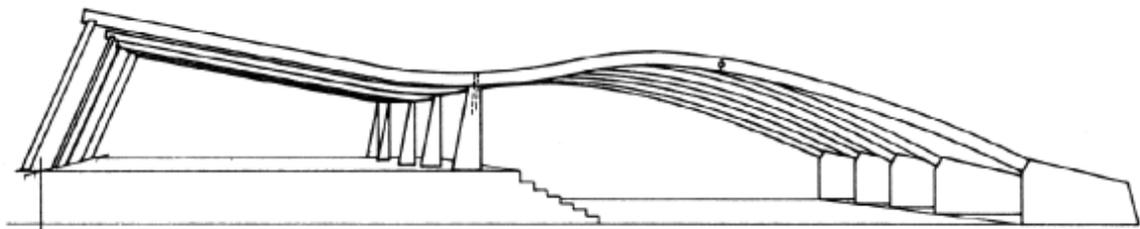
Structure pour hall de sport : arcs de section constante ; moises sur appuis par les poutres droites (portée de 20 à 40 m et plus entre appuis).
